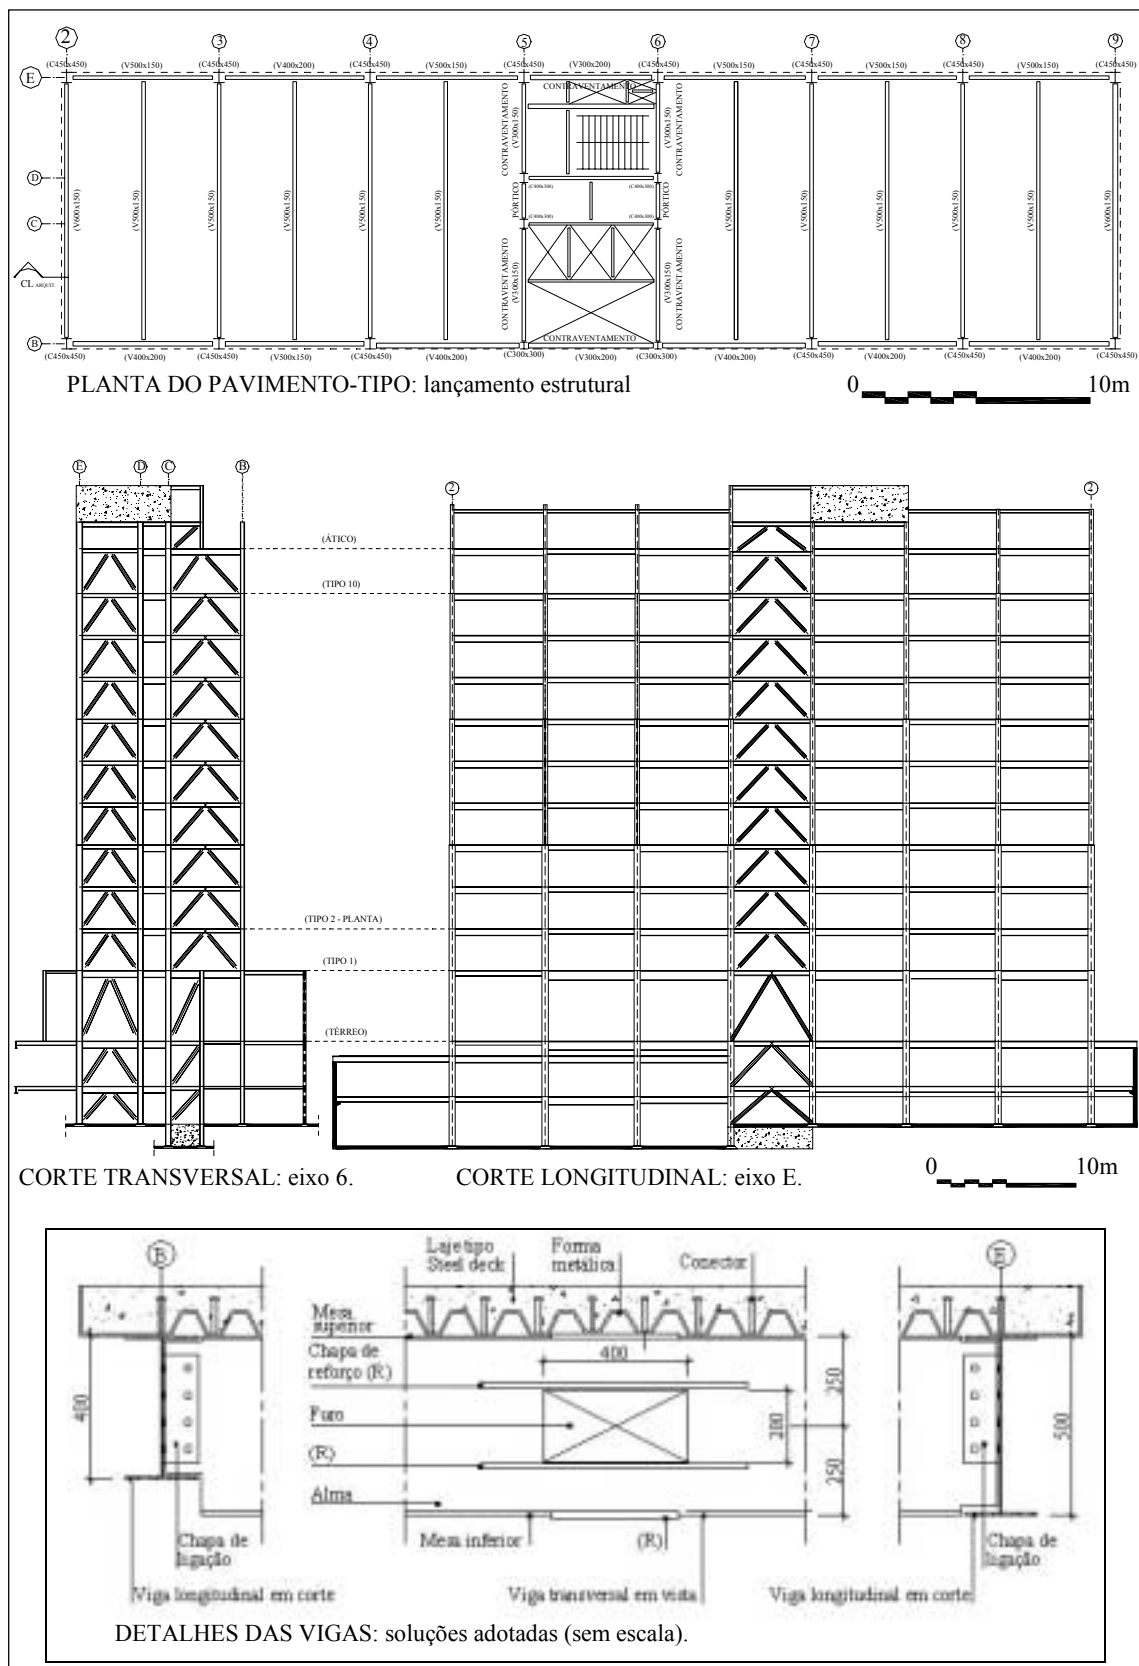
Solução estrutural do edifício E-3: esboços da planta, dos cortes e de detalhes.
